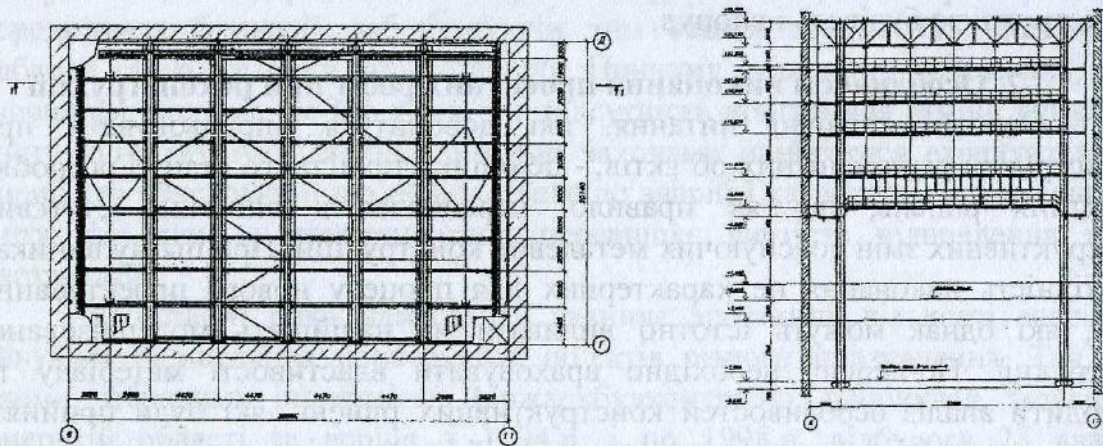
Схема розташування ферм, балок настилу та в'язів по нижнім поясам ферм
